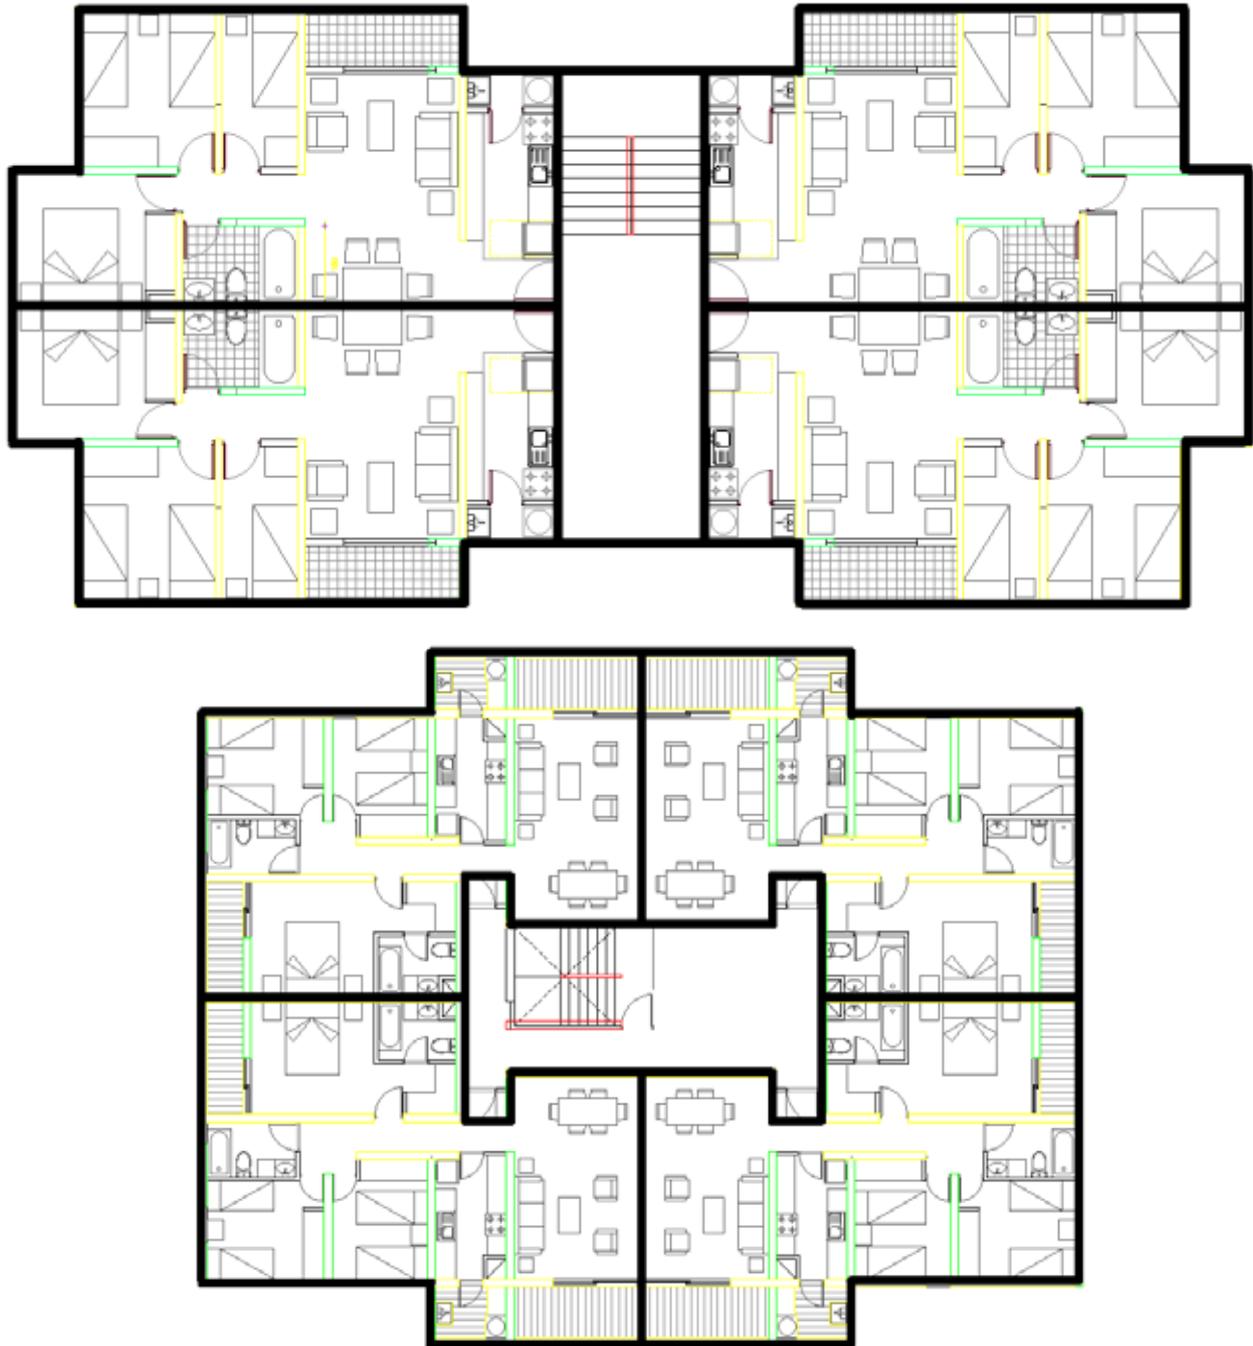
Planta edificio 5 pisos para sectores vulnerables (1.332 m<sup>2</sup>) arriba y sectores emergentes (2.183 m<sup>2</sup>) abajo. Fuente: (CIM UC, 2019a).
